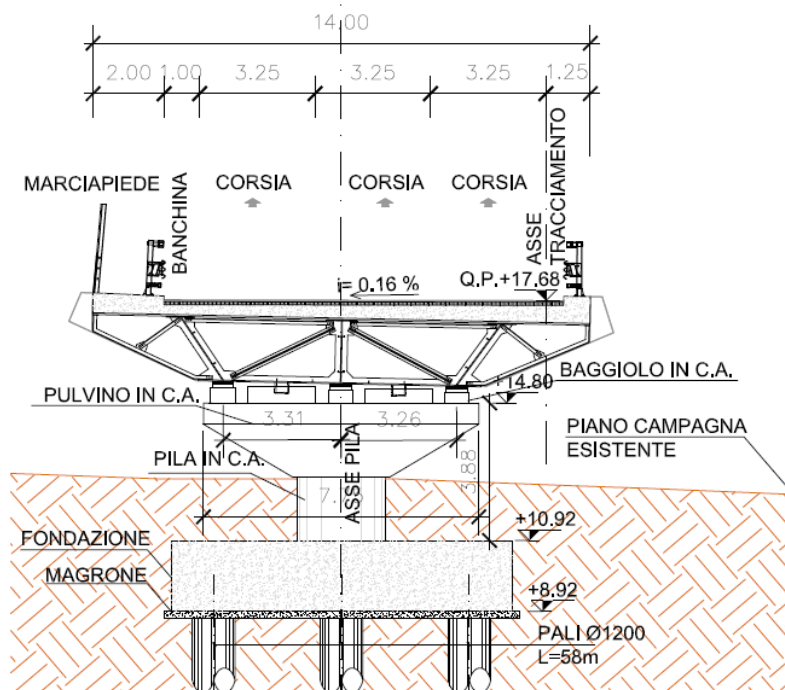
Viadotto VI06 - Sezione trasversale su pila
